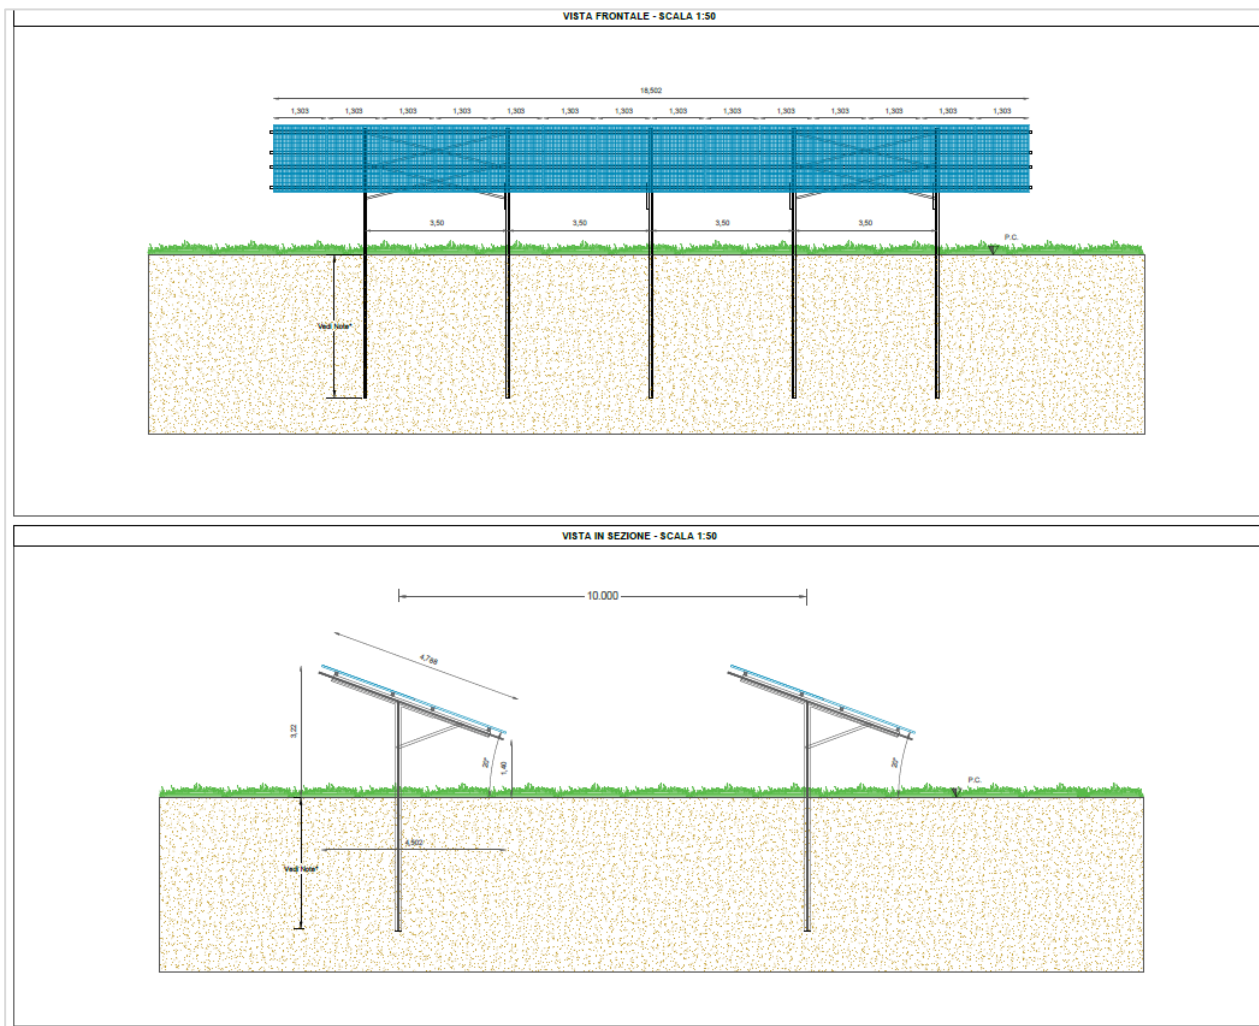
Stralcio elaborato “CEN.ENG.TAV.032_DISEGNI DELLE STRUTTURE DI SOSTEGNO E DELLE OPERE DI FONDAZIONE”
